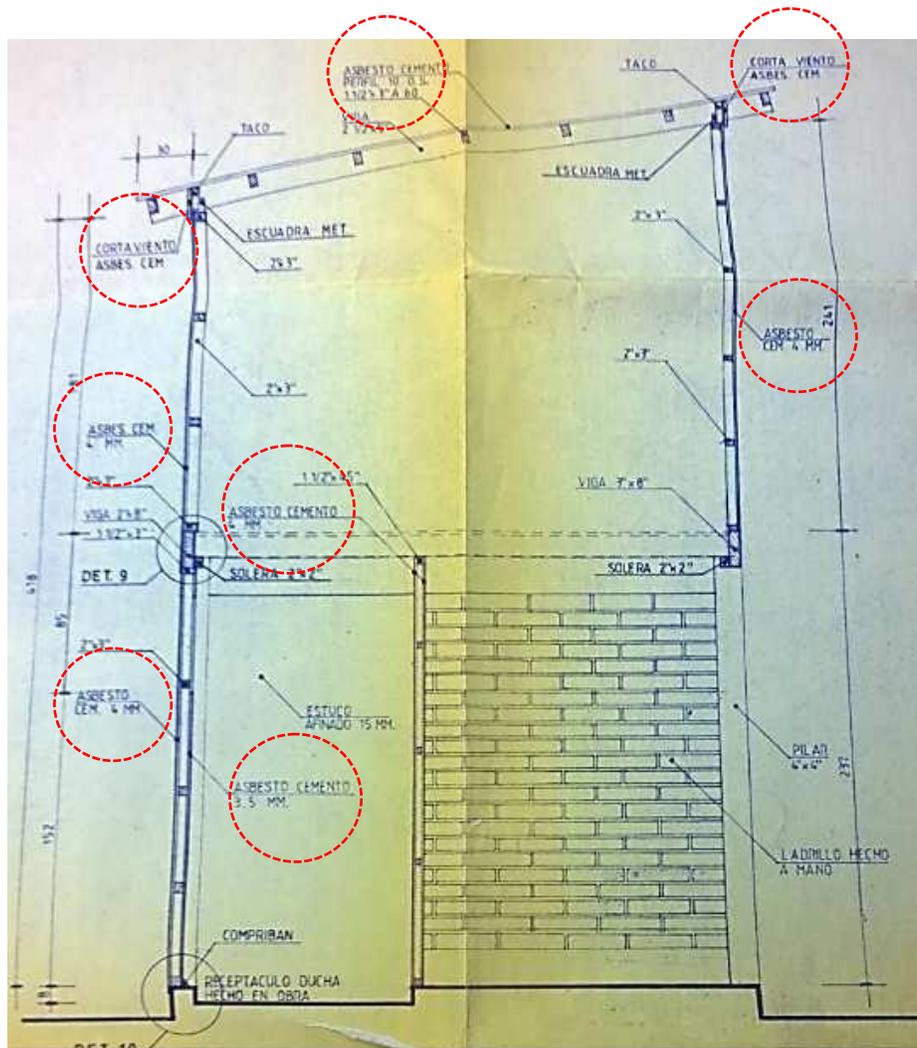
Sección lateral, corte de bloque tipo de vivienda
